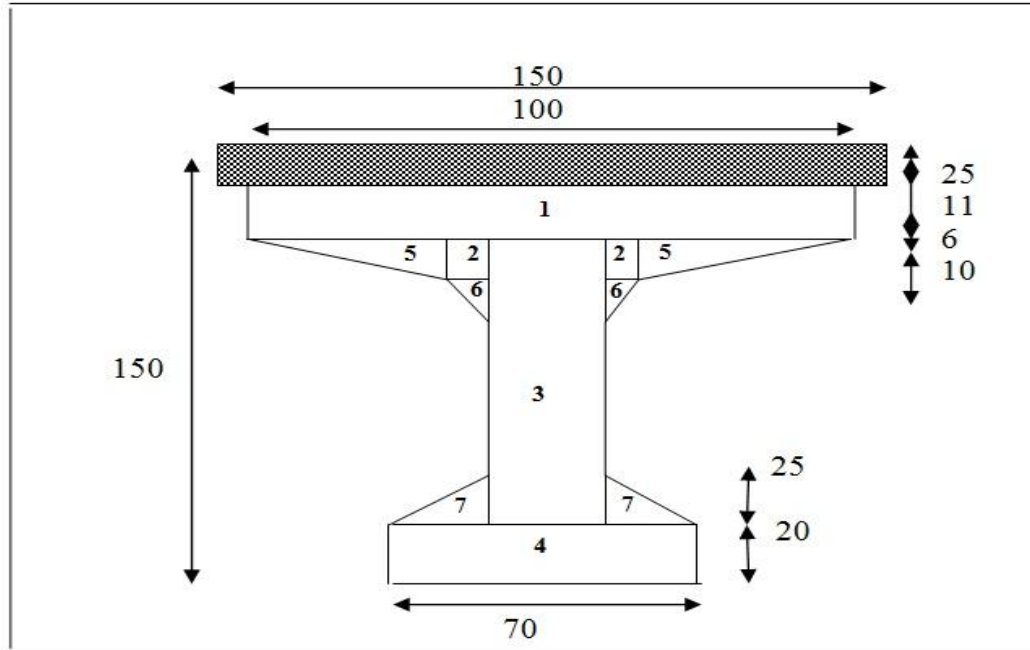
Section de La poutre avec hourdis a mi travée
